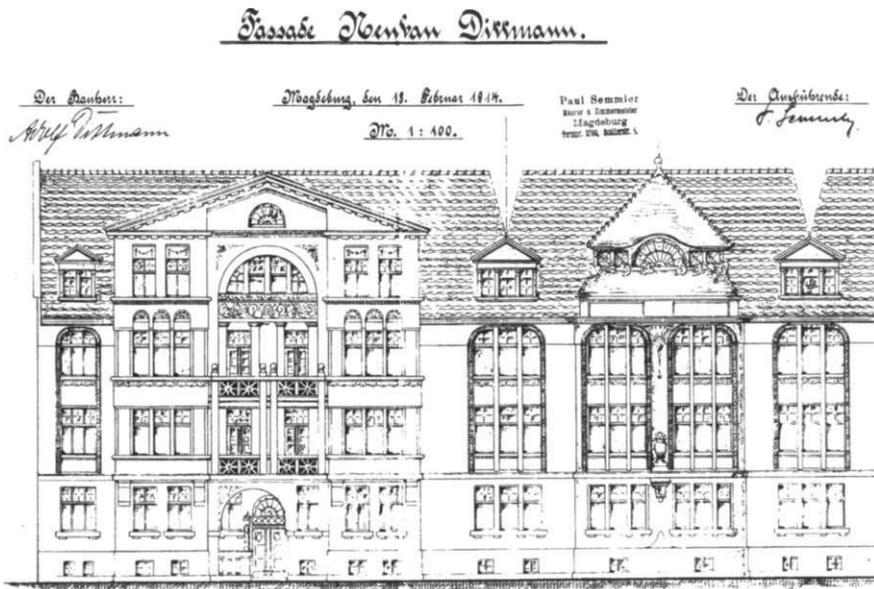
Wilhelm-Kobelt-Straße 5, Fassadenaufriß an der Wilhelm-Kobelt Straße und an der Straßenecke
